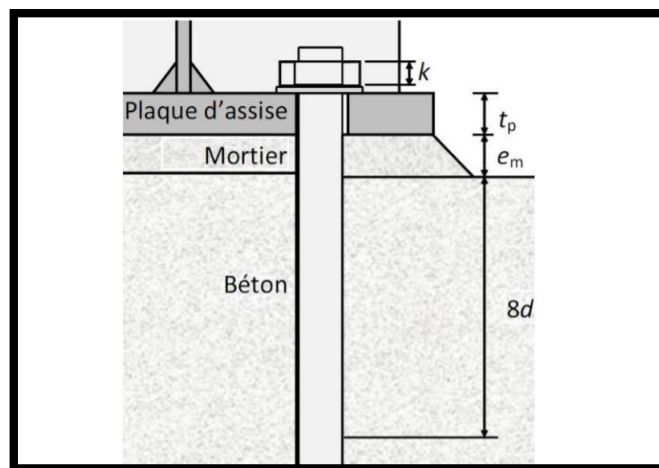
Longueur d'allongement du boulon d'ancrage.
